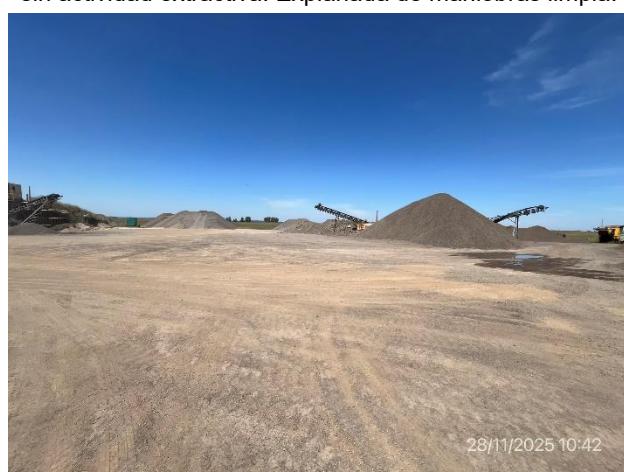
, P04. Planta de trituración. Hay acopios listos de material triturado.
